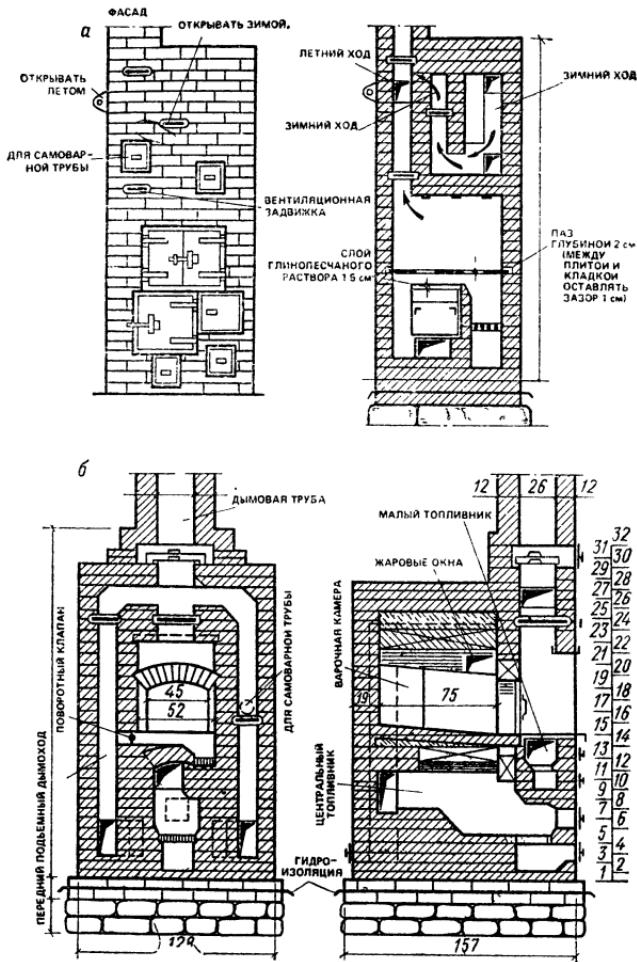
Отопительно-варочные печи конструкции Коробанова и Самарина (а), Ковалевского (б)
